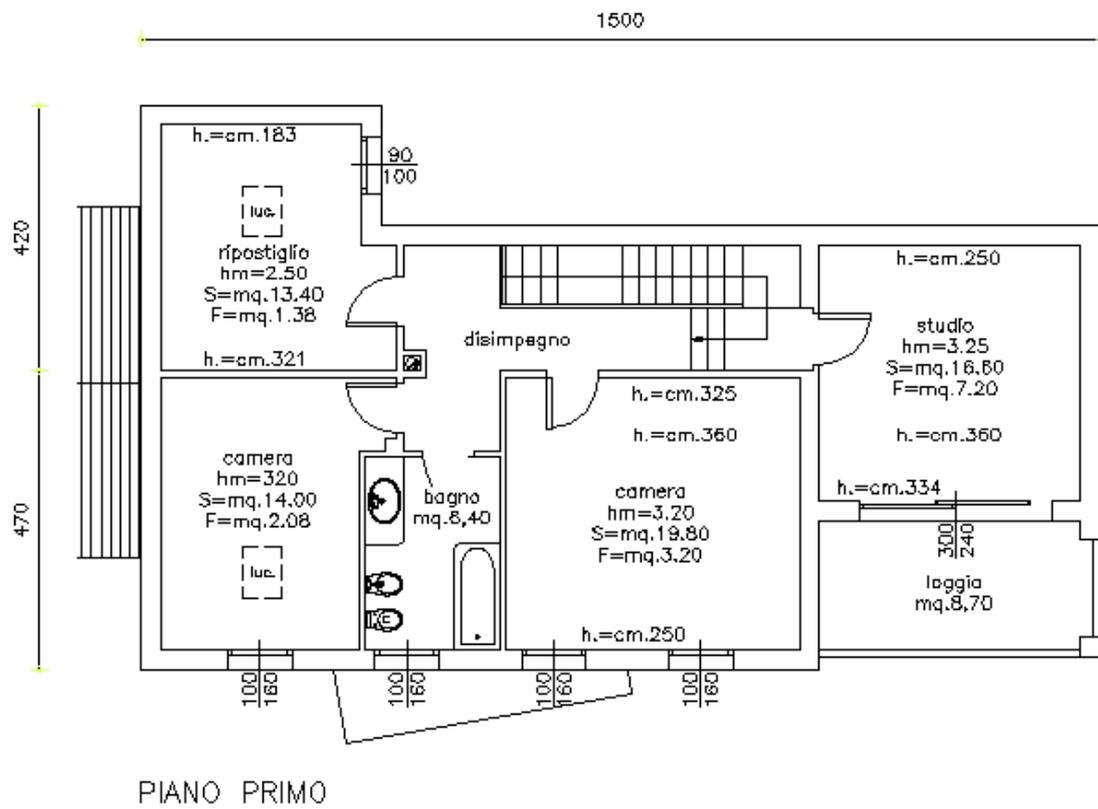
Primo piano dell'abitazione residenziale singola
